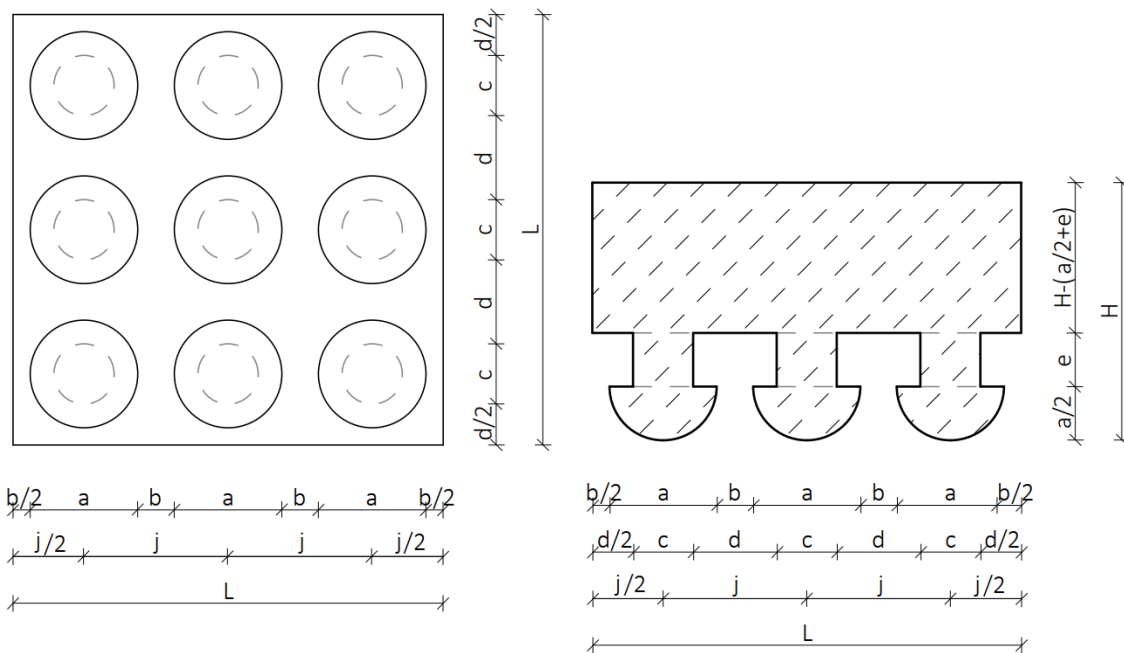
Betonkörper in Untersicht (li) und Schnitt (re)
